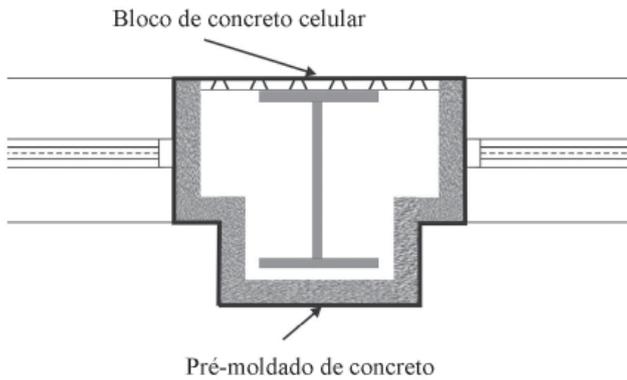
Pilar de fachada com elemento pré-moldado.
